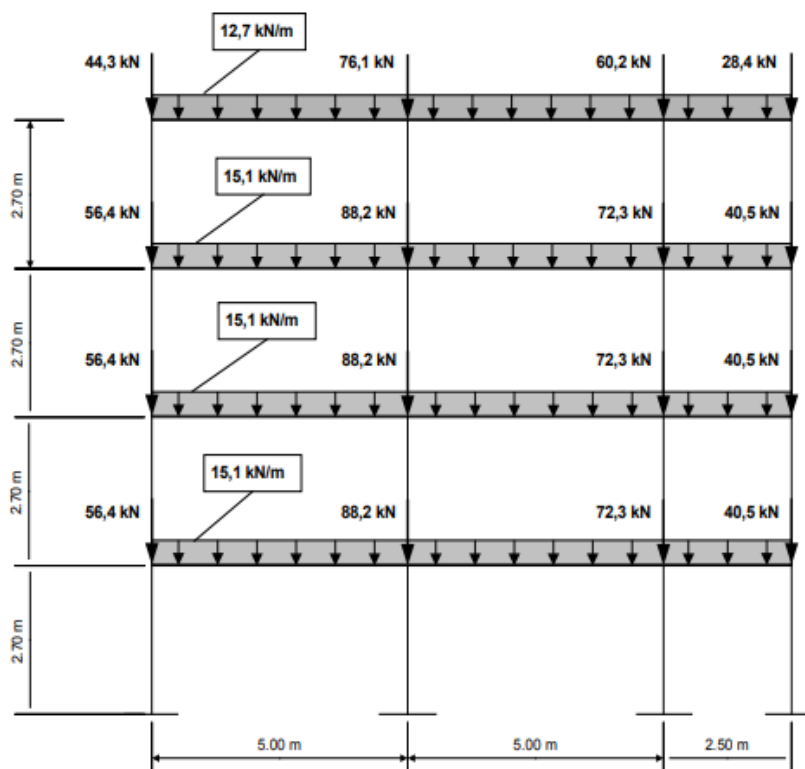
Carregamento da estrutura (Pinto et al. (1999))
